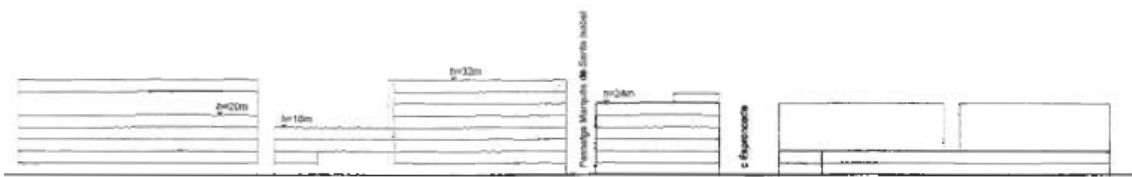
Corte C-C' de la AD del PERI Parc Central. Sección transversal de la calle Marroc con vista a Bolivia y Perú
